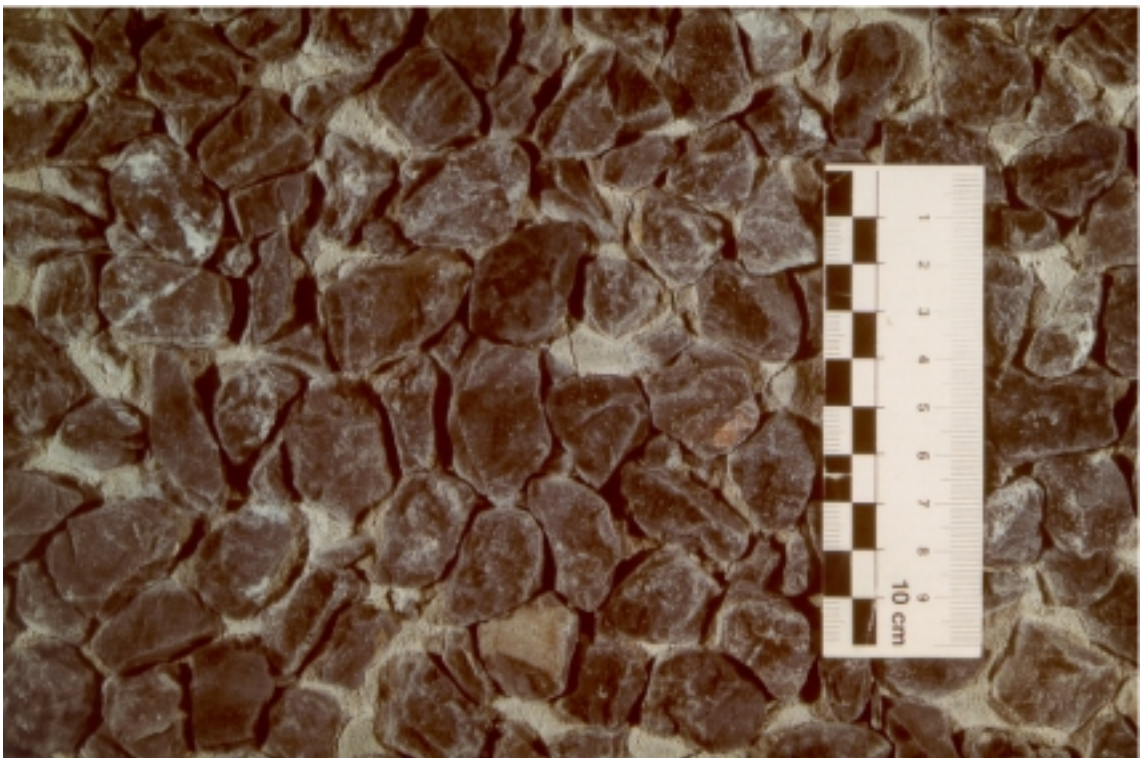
Waschbetongrundkörper Splitt, Rauhtiefe ca. 6 mm
